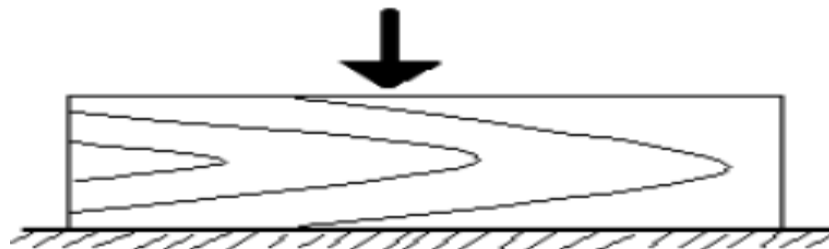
Muestra la posición de la probeta de madera al ser sometida a ensayo de compresión perpendicular a la fibra. (Díaz, 2005)
